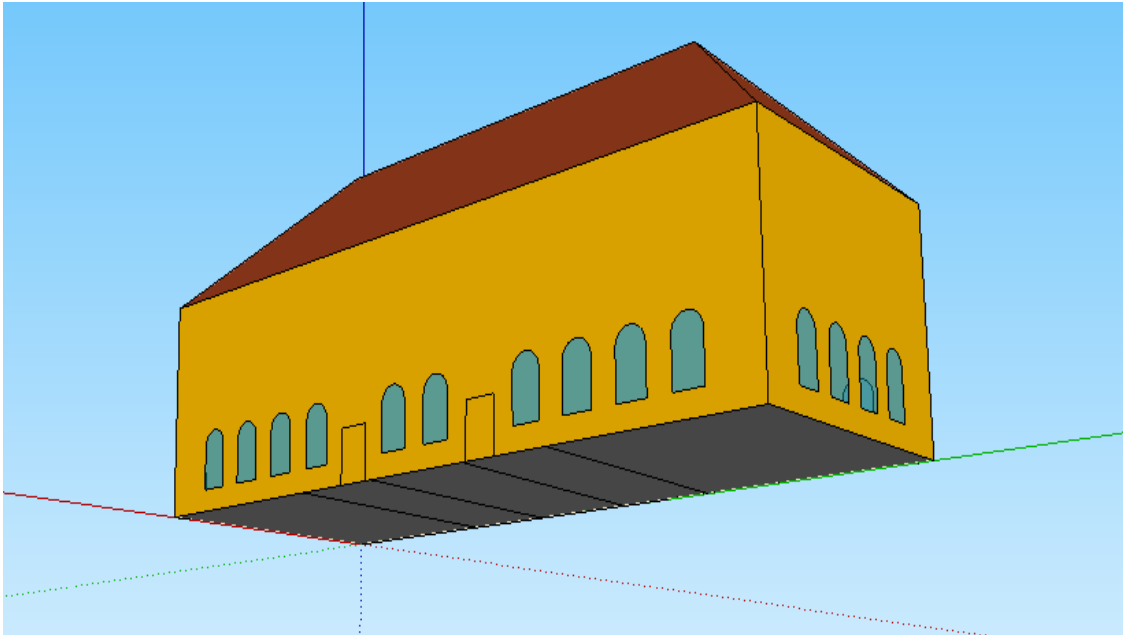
Vista dal basso del salone, visibile la divisione in cinque zone del pavimento
